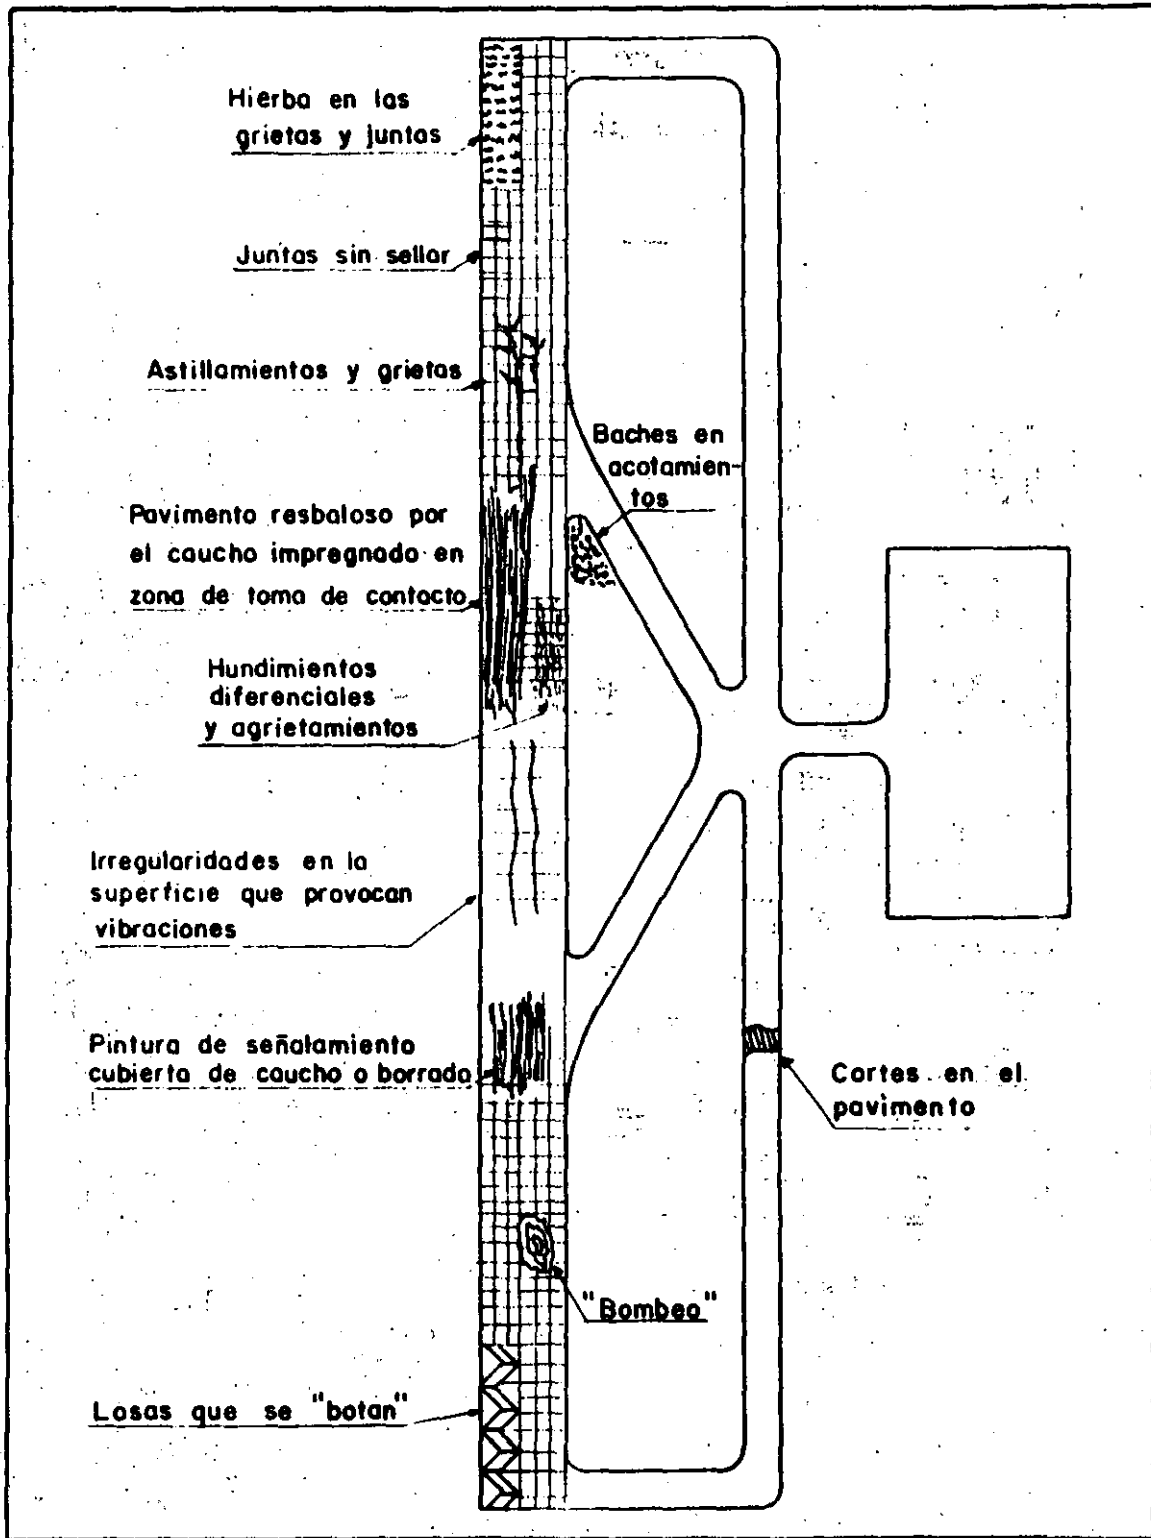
Detalles a observar en pavimentos rígidos
